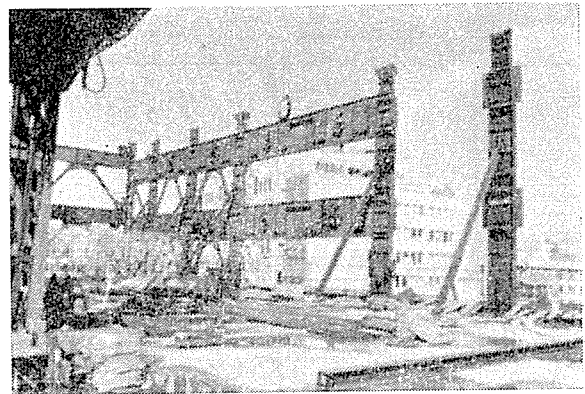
(a) 鉄骨大ばり（孔はPCケーブル貫通孔である）
